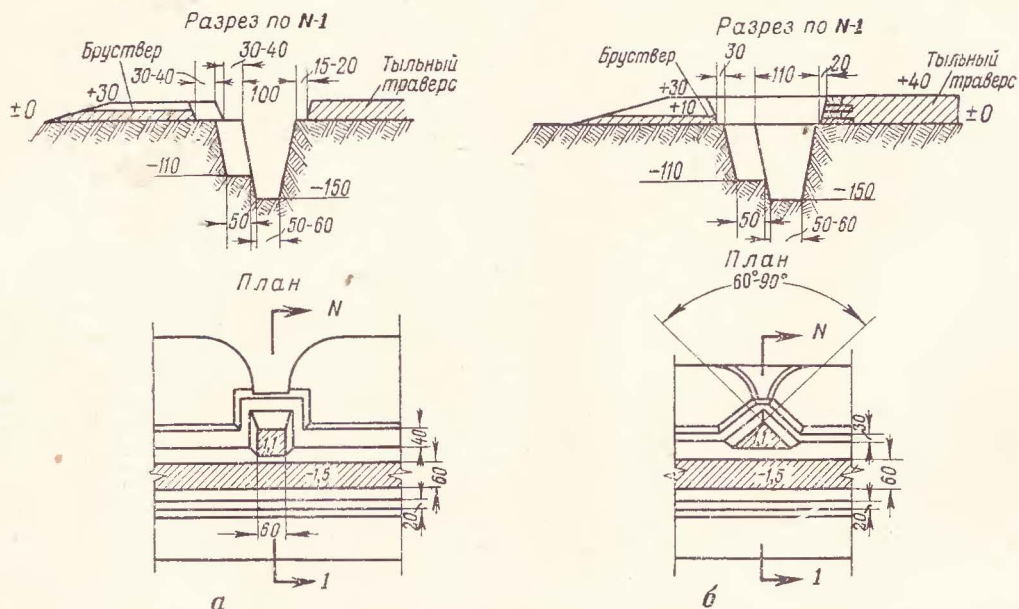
План и разрез примкнутой стрелковой ячейки с прямоугольным (а) и треугольным (б) начертаниями в плане
